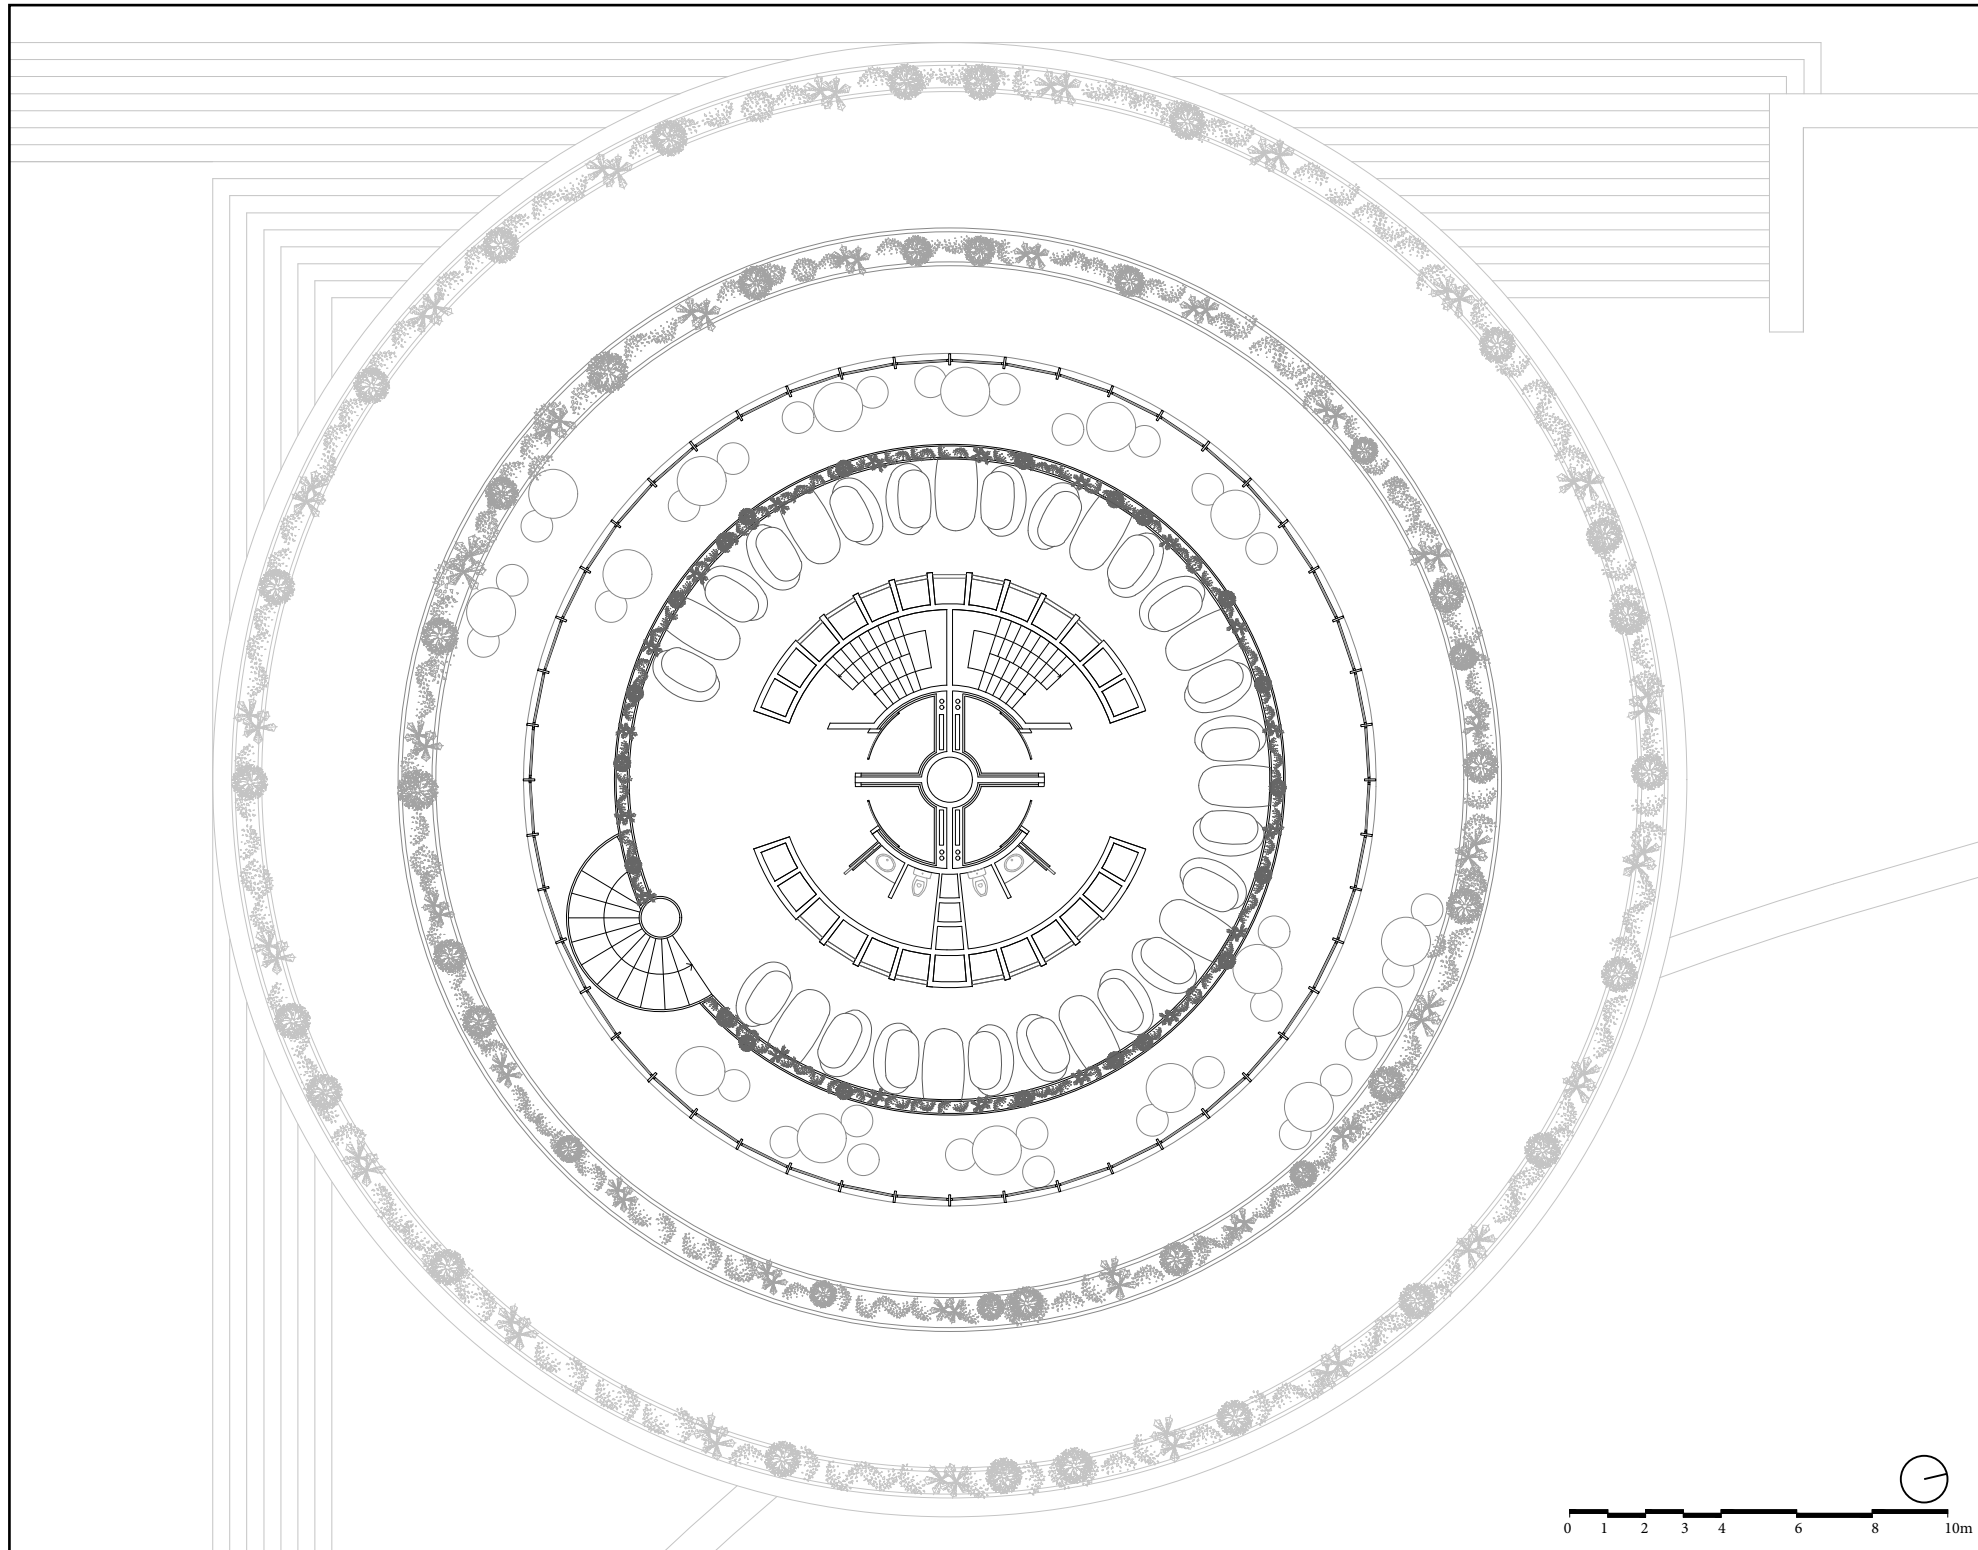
Séptima Planta. Bar. [Fuente: Autor]
